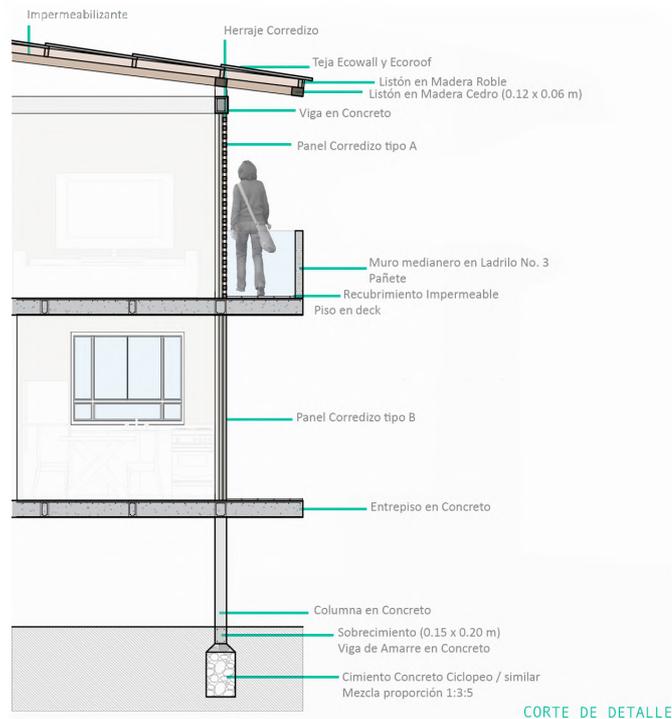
"Detalle Estructura" Elaboración propia a partir de: Alejandra Jiménez
